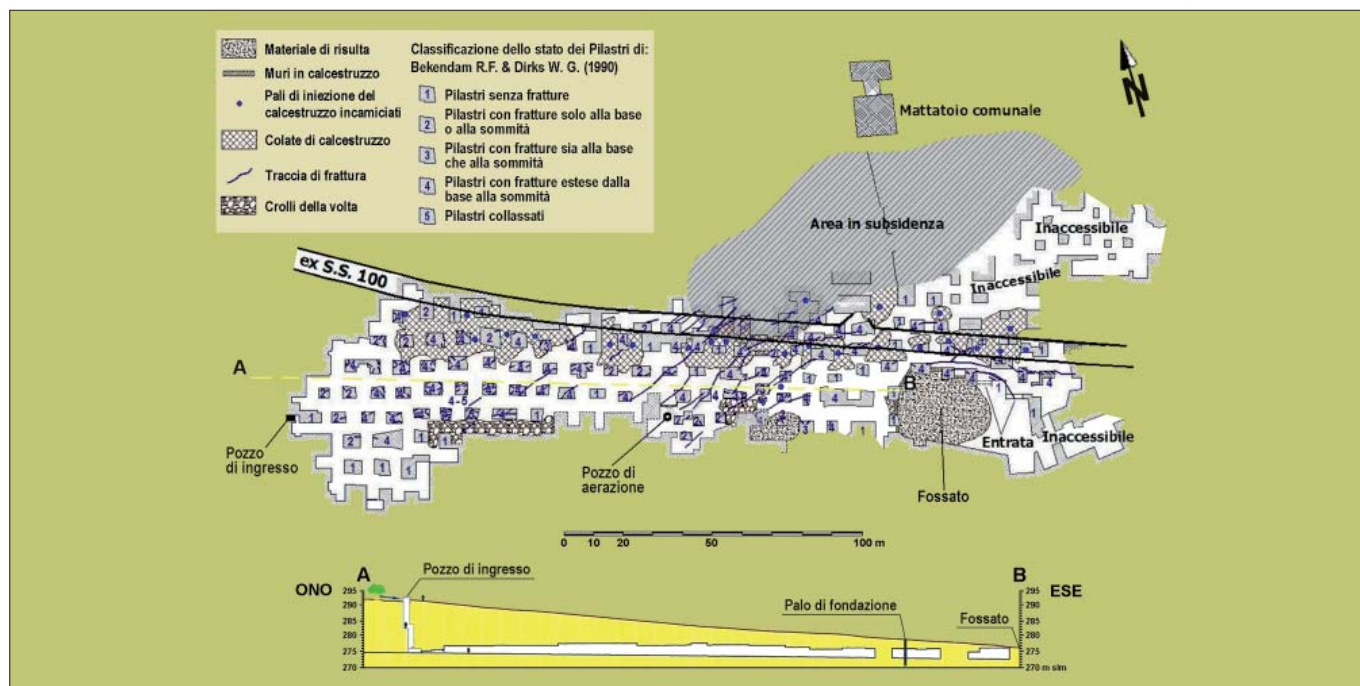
Planimetria e sezione longitudinale della cava di Via S. Allende, Mottola (TA) con classificazione della stabilità dei pilastri, secondo la metodica proposta da Beckendam R. F. & Dirks W. G. (1990), da rilievo geomeccanico del 1995-1996
